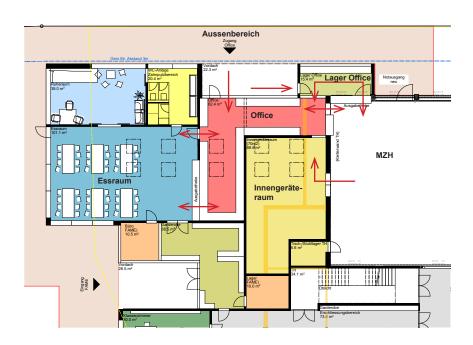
Planausschnitt Erdgeschoss - FAME, Office und MZH
